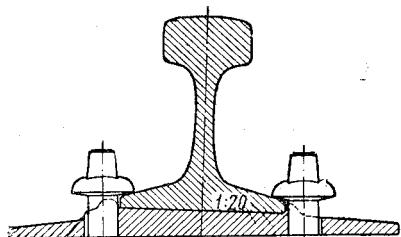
Общий вид промежуточного скрепления нераздельного типа
